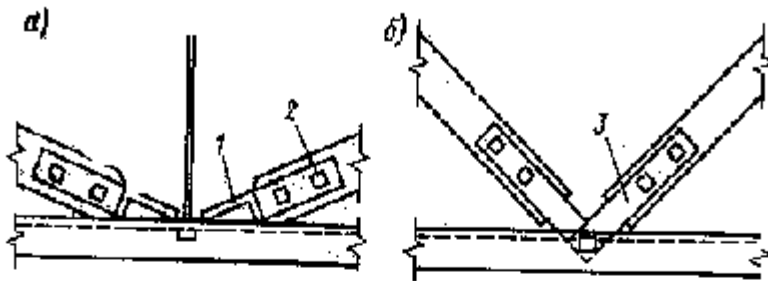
Вузли нижніх поясів клеєдерев'яних ферм:
